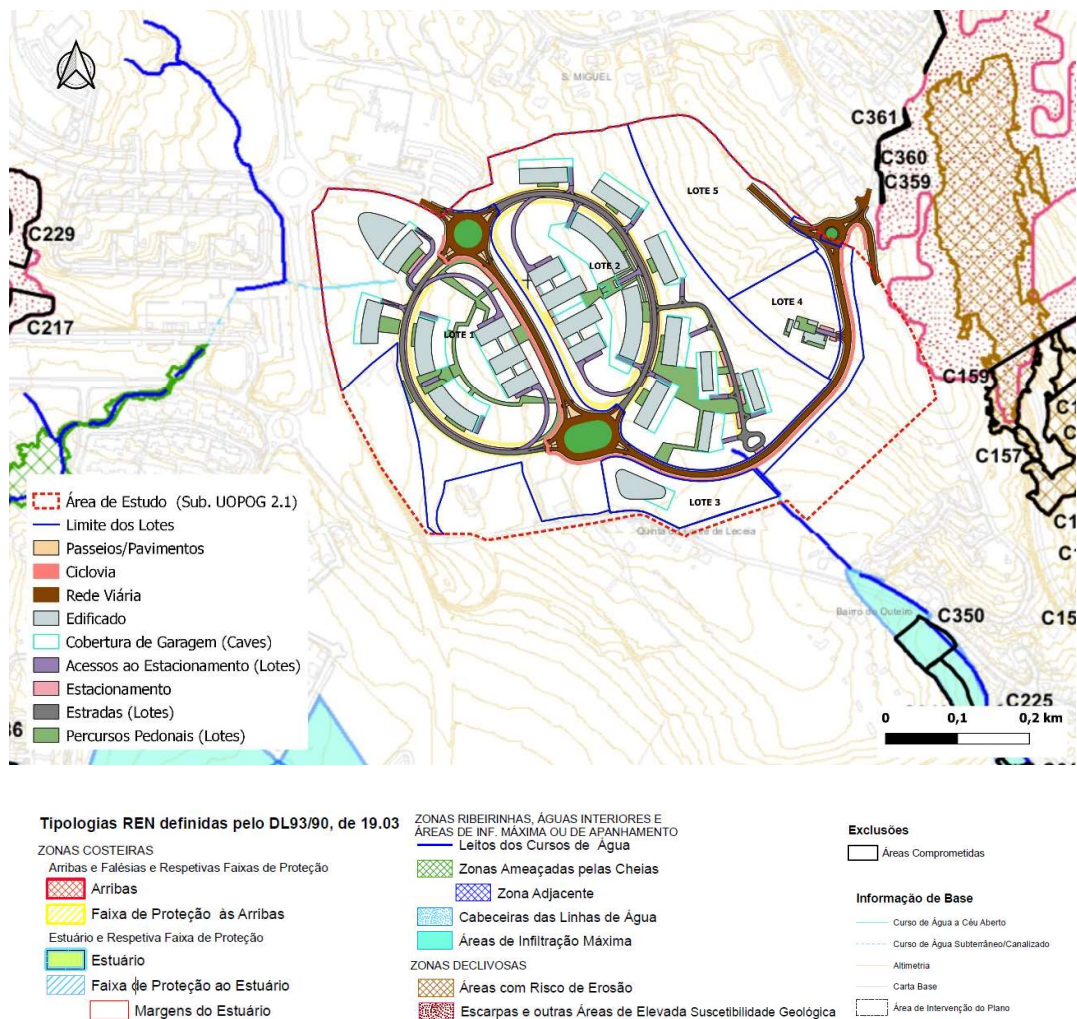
Enquadramento da área de estudo na Planta de Condicionantes – Reserva Ecológica Nacional (REN), alternativa de traçado. Fonte: (Adaptado da DGT, 2021)
